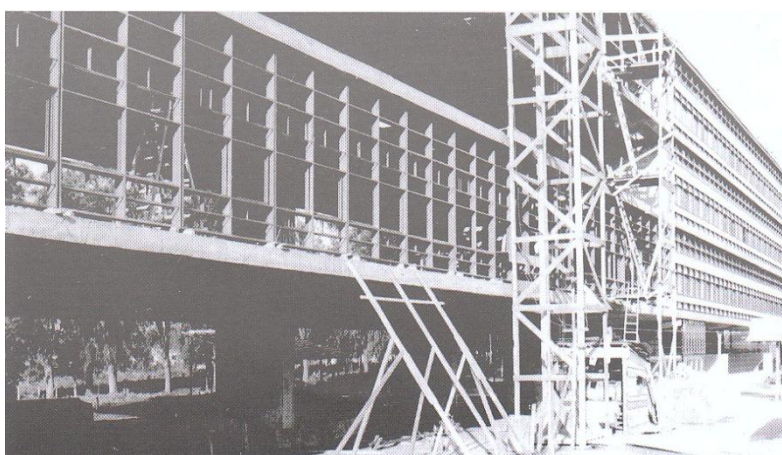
Construção do Edifício E1 – Colocação dos caixilhos
